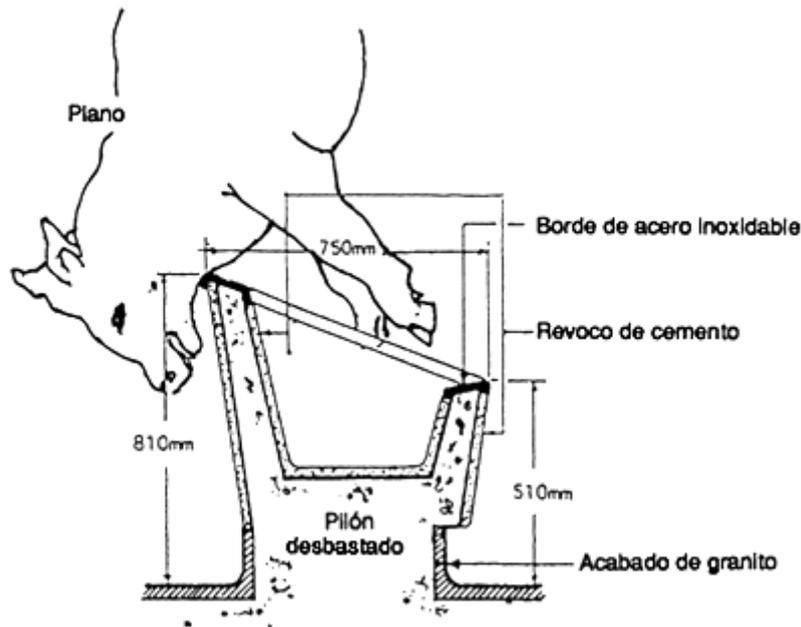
SECCION TRANSVERSAL DEL PILON PARA SANGRE
